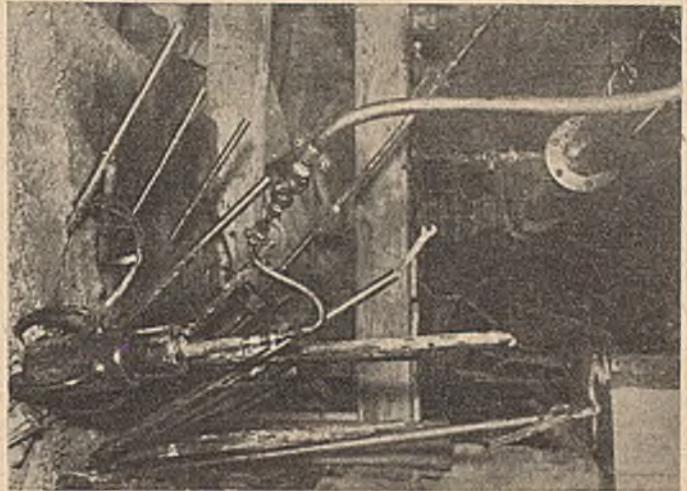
Verfestigung des Baugrundes unter einem Gebäudefundament der Schultheiß-Patzenhofer-Brauerei in Spandau von einer Seite aus durch schräg eingerammte Einspritzrohre.
